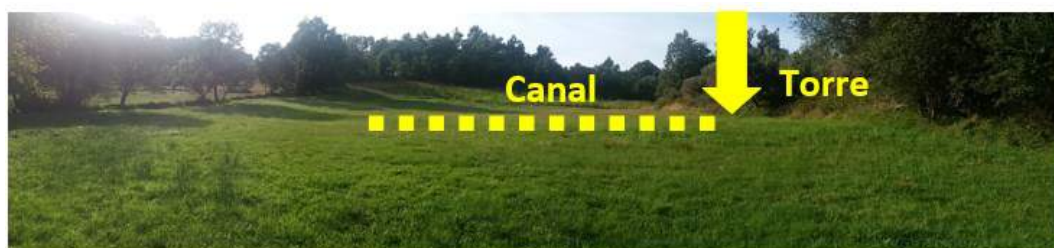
Descarga de Fundo. Vista geral da zona de restituição, em solos colúvio-aluvionares
